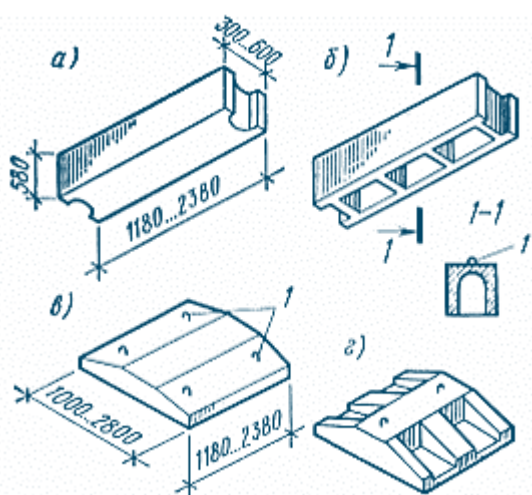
Елементи збірних бетонних і залізобетонних фундаментів:
